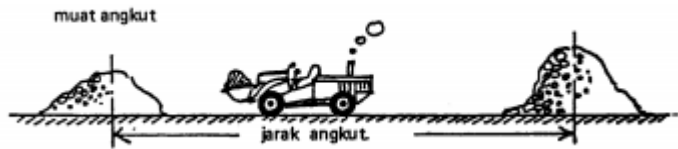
Wheel Loader dalam Pekerjaan Produksi Beton di Batching Plant
